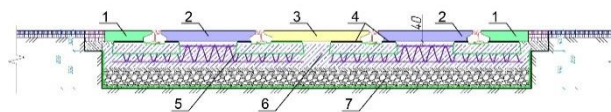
Розріз безбаластної технології RS, з покриттям бетонними плитами: 1 – зовнішня плита; 2 – дорожня плита; 3 – міждорожня плита; 4 – опорні площадки; 5 – опорний елемент ДОЕ1; 6 – бетон C25/30; 7 – основа зі щербеном 20–40
